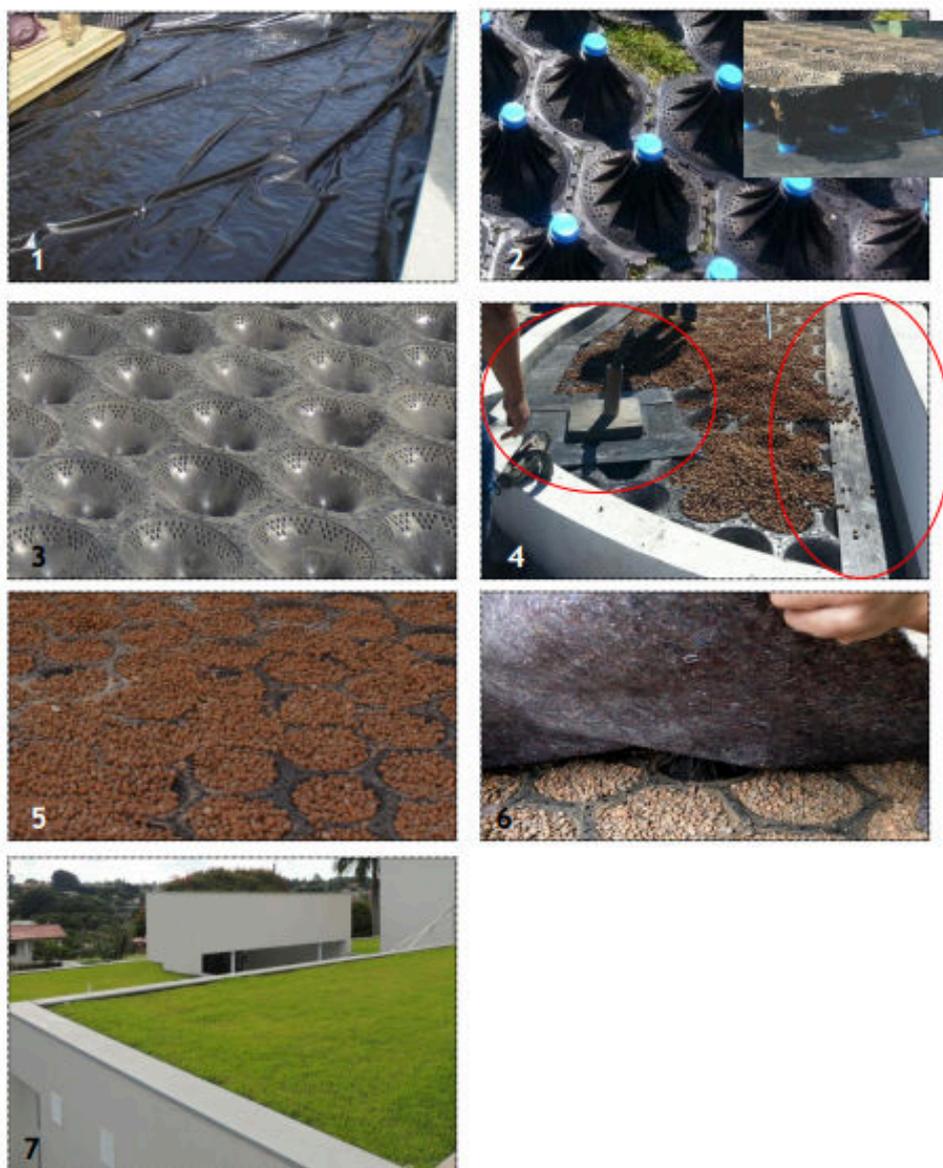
Passo a passo para instalação do sistema laminar alto.
